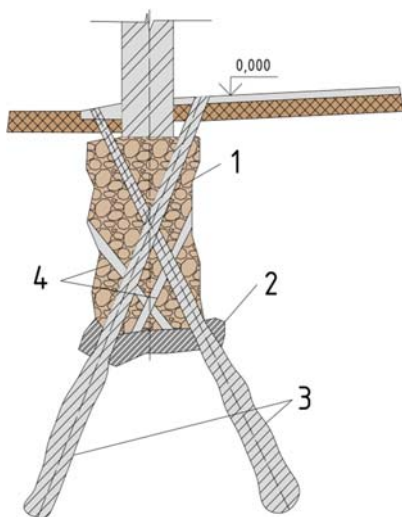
Схема усиления основания фундамента с помощью буроинъекционных свай ЭРТ (РИТ, ФОРСТ, ЭРСТ):
